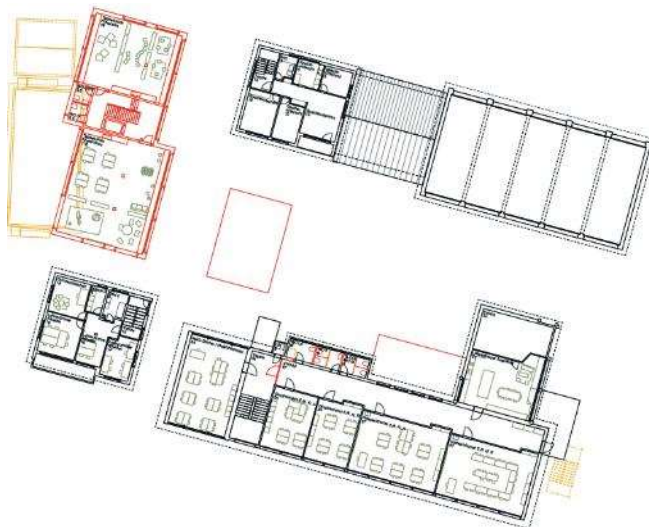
Schlussabgabe, Grundriss Obergeschoss des Team Johannes Saurer Architekt mit Xeros Landschaftsarchitektur GmbH
